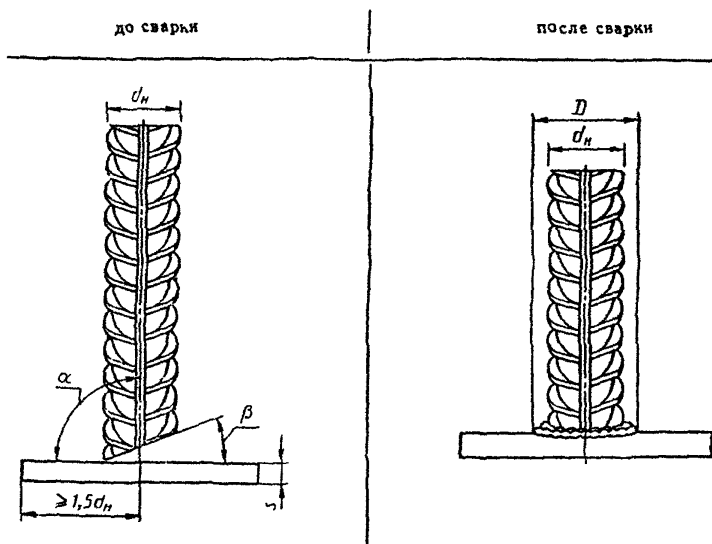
Конструкция таврового соединения, выполняемая контактной сваркой оплавлением (тип К7-К0)
